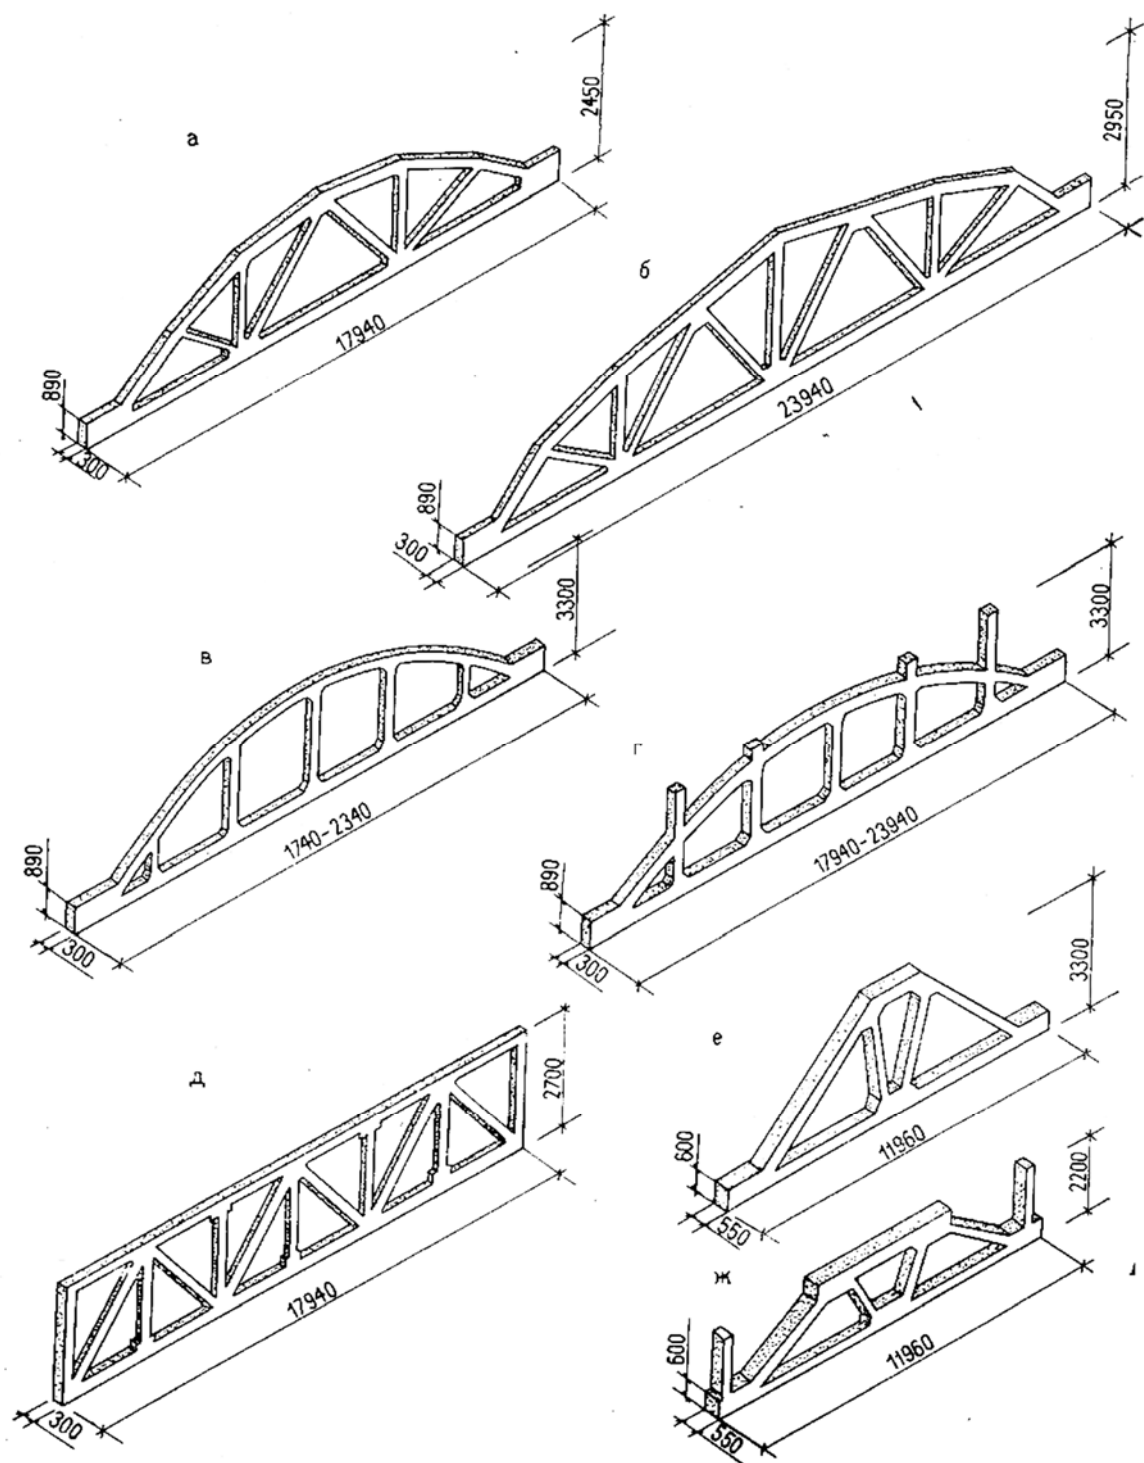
Типы железобетонных стропильных ферм [38]:
